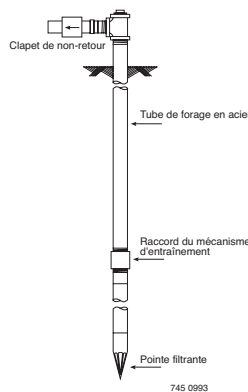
INSTALLATION D'UN PUIT À POINTE FILTRANTE
